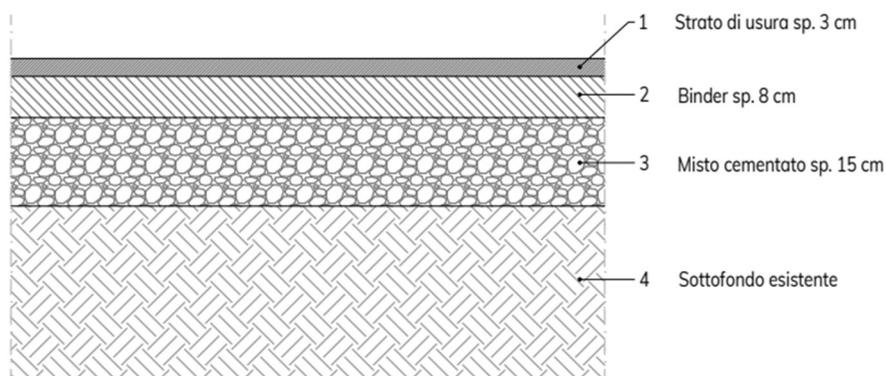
Ripristino pavimentazione e marciapiede lungo via Boito
